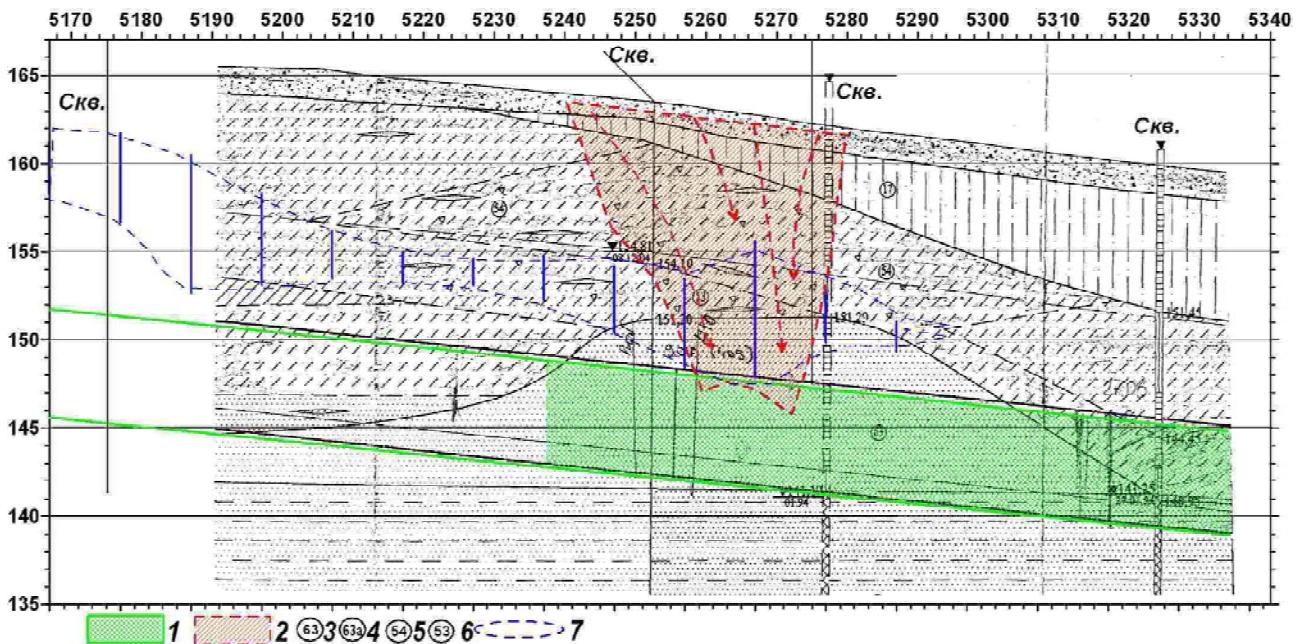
Геологический разрез участка строительства туннелей метро на перегоне между станциями “Голосеевская” – “Васильковская” (ПК 51+67 – ПК 53+40): 1 – зона подземной выработки на 15.07.08; 2 – провальная зона; 3 – песок; 4 – песок, насыщенный водой; 5 – суглинки; 6 – супесь; 7 – зона увлажнения грунтов по геофизическим данным
